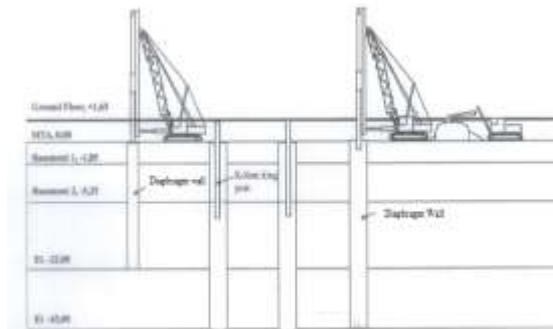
Alur Pengerjaan Diaphragm Wall
